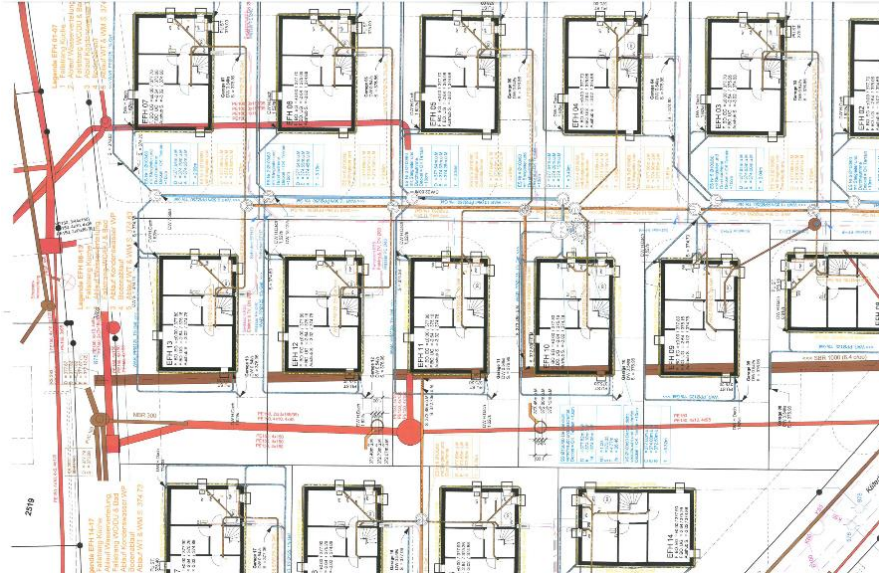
Planausschnitt Bauvorhaben, bestehende Kanalisationsleitung in Braun (ursprüngliches Projekt)
